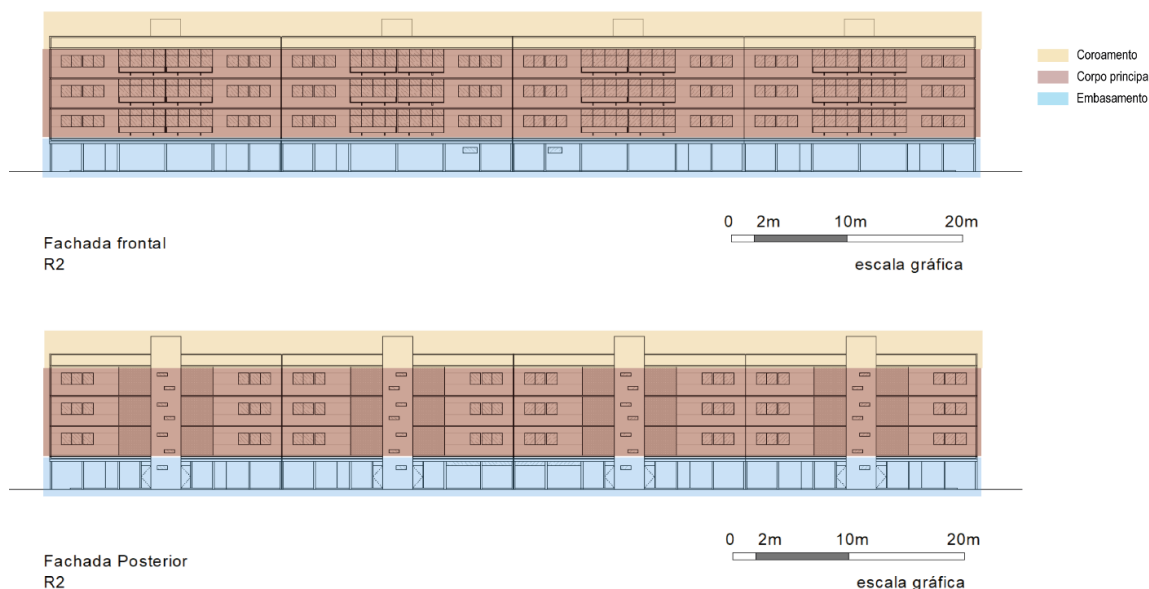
Esquema de composição da fachada frontal e posterior do R2. Fonte: da autora.
